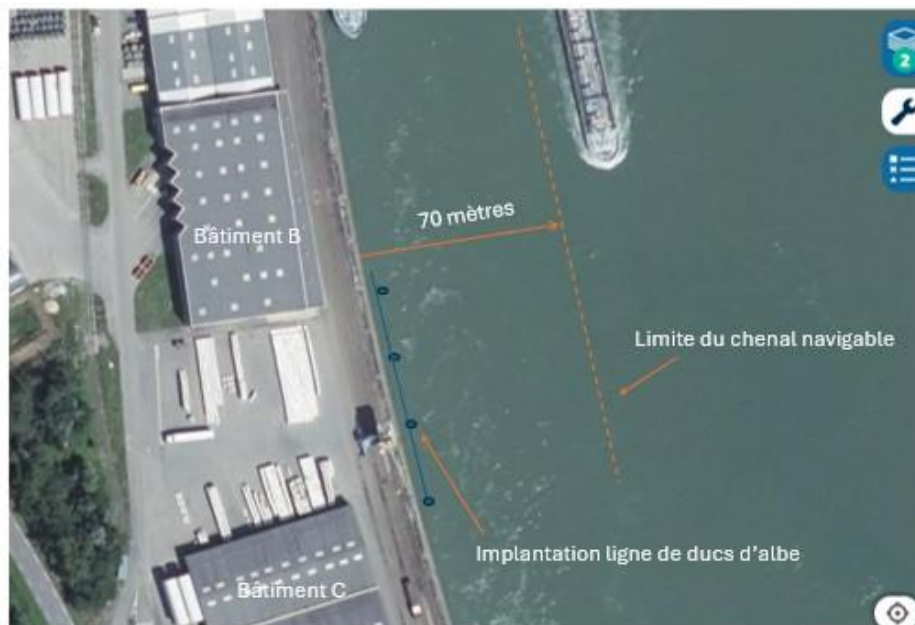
Vue en plan et emplacement par rapport au chenal navigable
